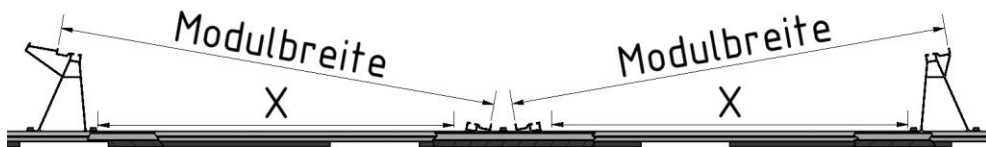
„Stützen oben“ mit Abstand „x“ mit je 2 Schrauben M8x16 mit der Bodenschiene verschrauben
